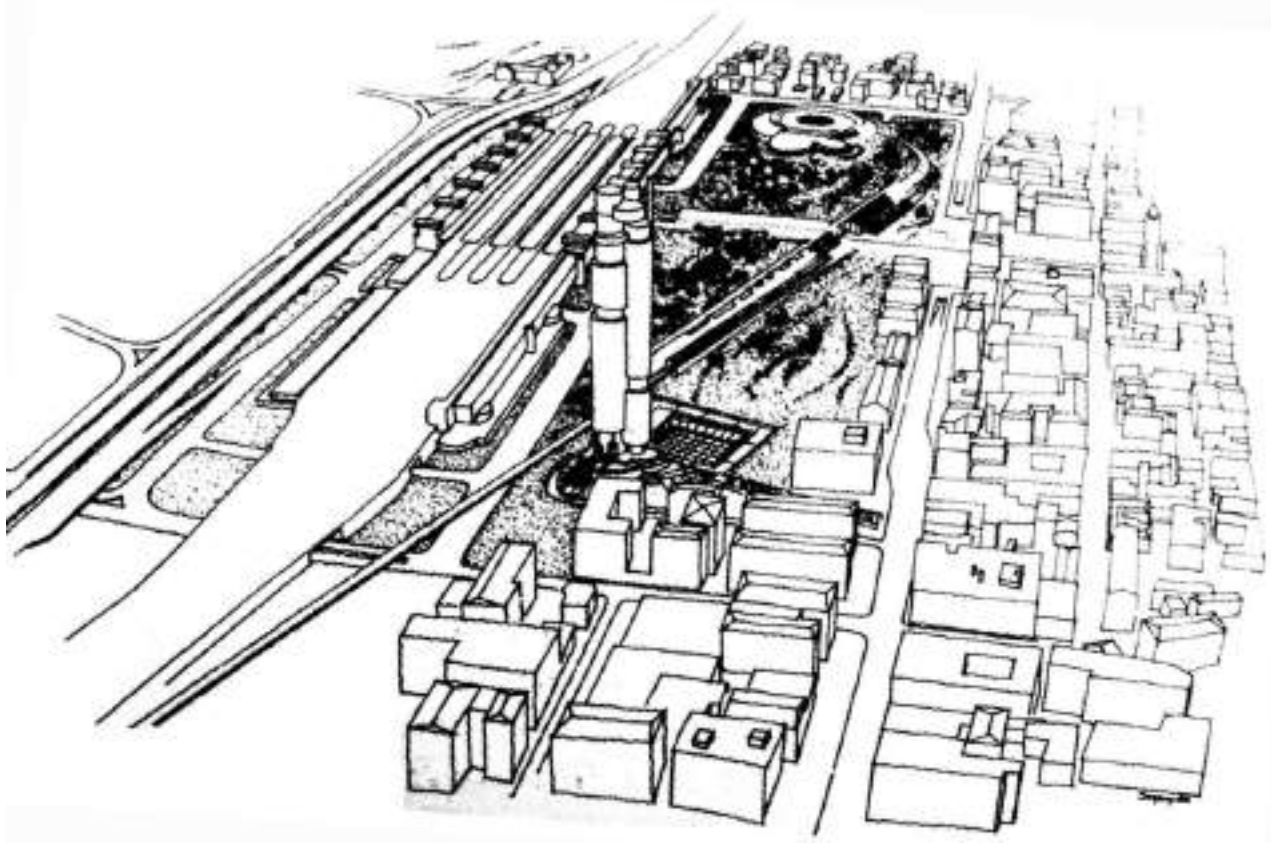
Prospettiva del progetto di stazione dell'arch. Favini del 1968
